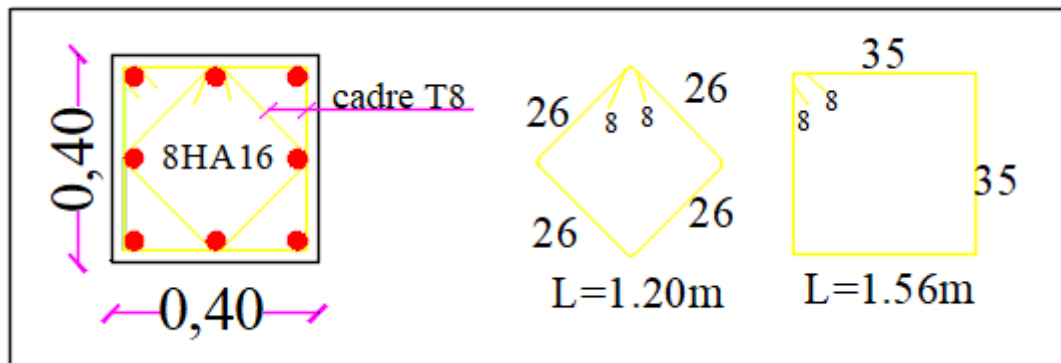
Ferrailage des poteaux 40 x 40.
